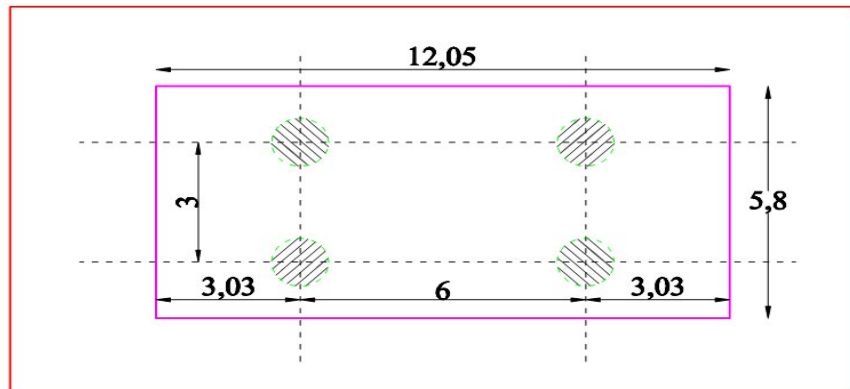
La disposition rectangulaire des pieux sous la semelle.
